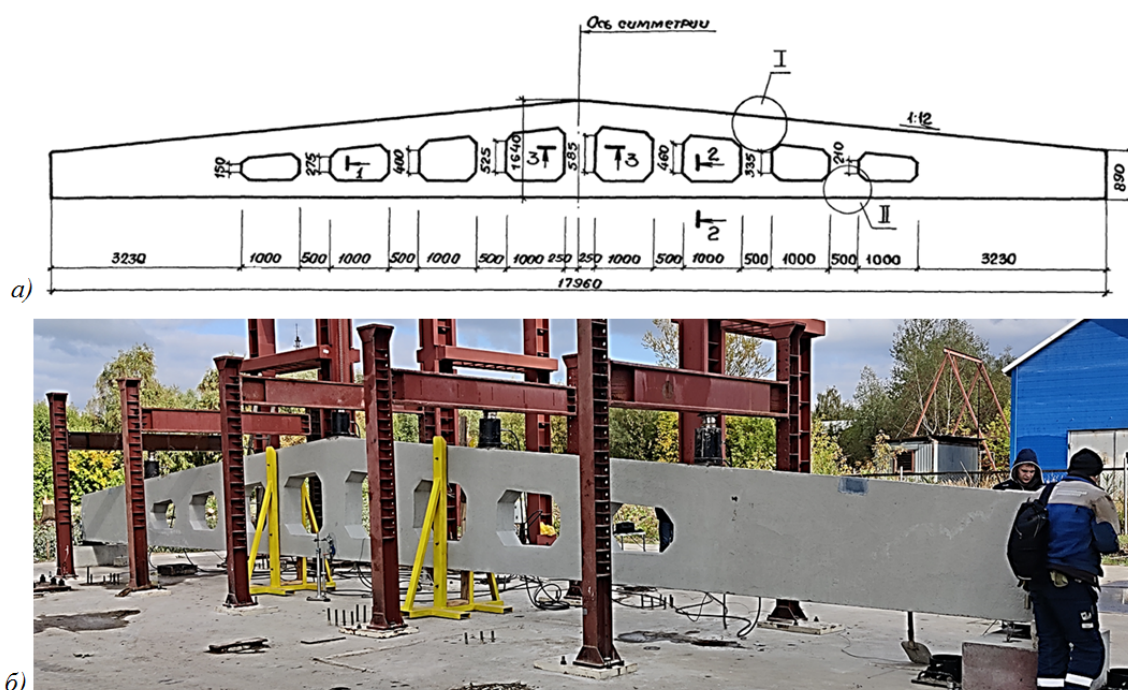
Стропильная балка ЗБДР18-5АШв-1 а) схема балки б) общий вид балки
